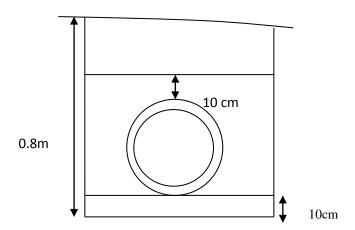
Pose de la canalisation en tranché dans un terrain accédante.
